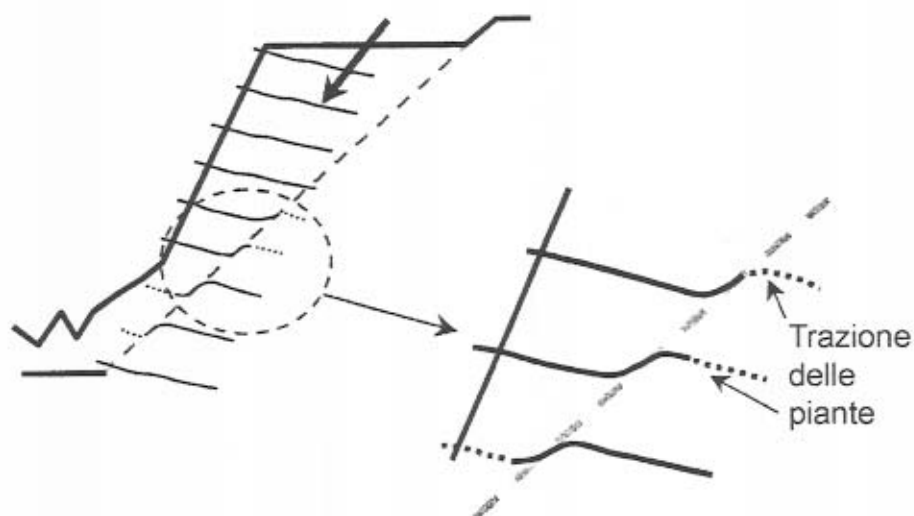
Instabilità di un pendio, con conseguente estrazione delle piante (SCHUPPENER, 2003)
